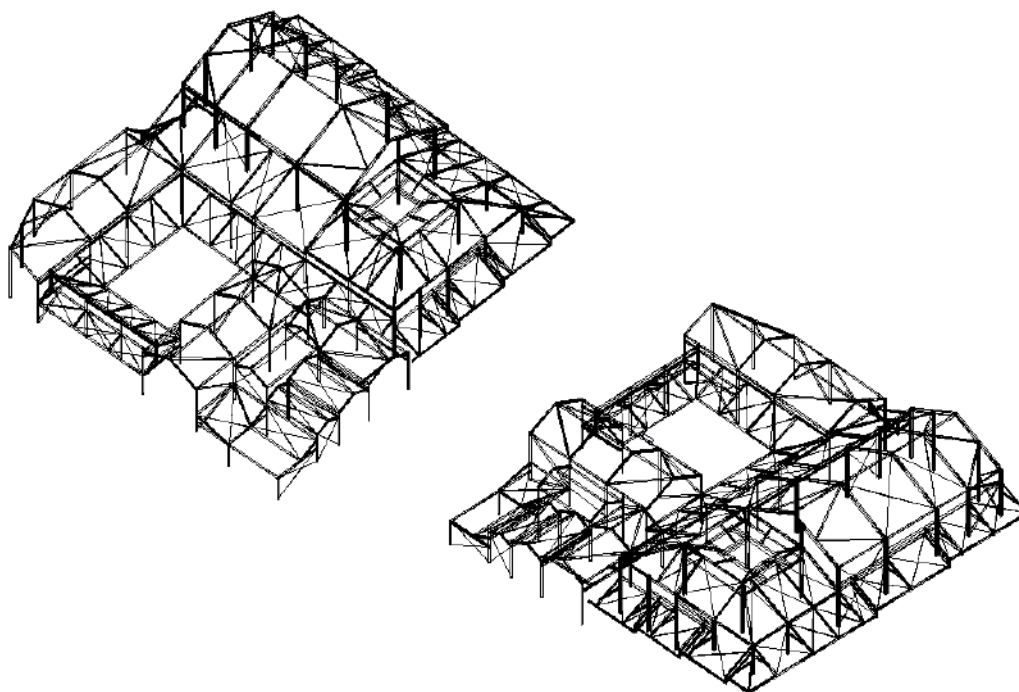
S3A - Estrutura Metálica da Cobertura – Perspetiva 3D
